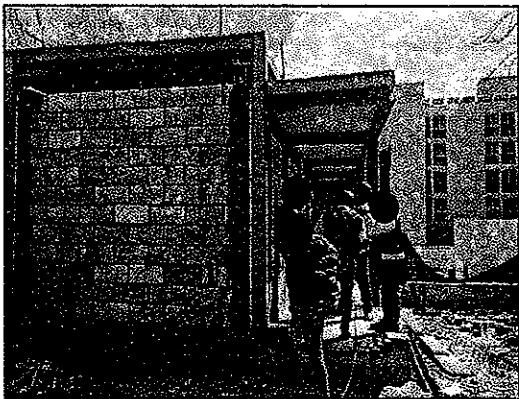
IMAGEN: Ampliación en el segundo nivel consistente en incorporación de marcos rígidos con vigas metálicas e implementación de losa de concreto.
